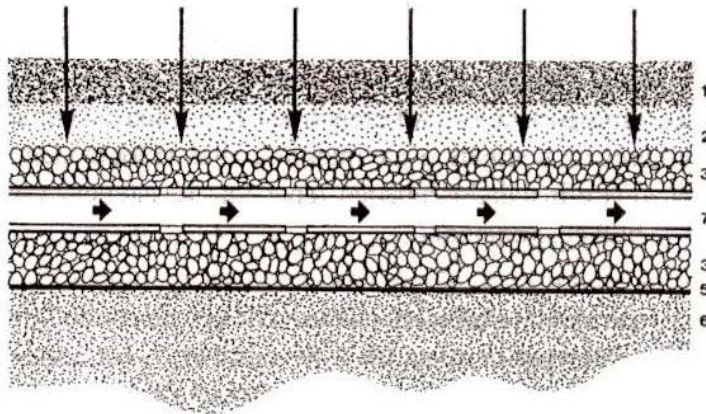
Disposición concentrada aparte. El agua que ingresa a la subbase se drena con tubos hacia afuera. 5.- Membrana impermeable, 6.- Subrasante de suelo nativo, 7.- Tubos de drenaje.
